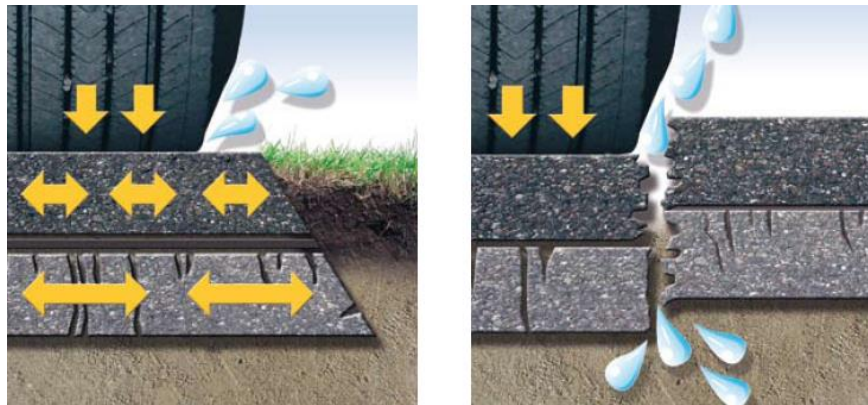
El geotextil en el pavimento (izq.) absorbe los movimientos diferenciales entre capas lo que evita la formación de grietas por reflexión. Además forma una capa intermedia impermeable que evita que el agua superficial penetre en la capa antigua. Sin el geotextil (der.) se produce una rápida reflexión de las grietas de la antigua a la nueva capa, además el agua superficial penetra sobre la capa antigua y acelera el deterioro de la carretera.
